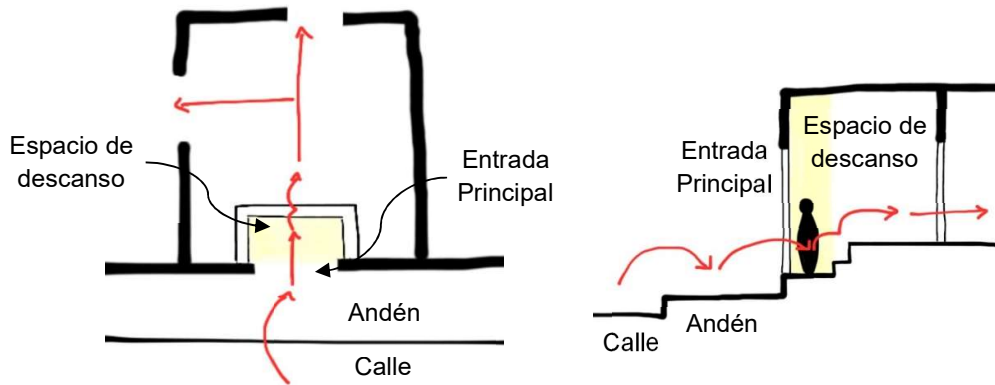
Planta y corte de un espacio de descanso con cambio de altura. Nota: Elaboración propia.
